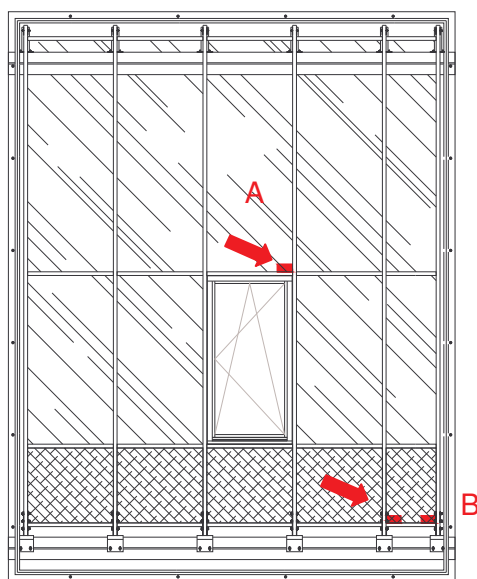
Schema delle infiltrazioni riscontrate nel campione alla pressione di 900 Pa (prospetto vista interna)
